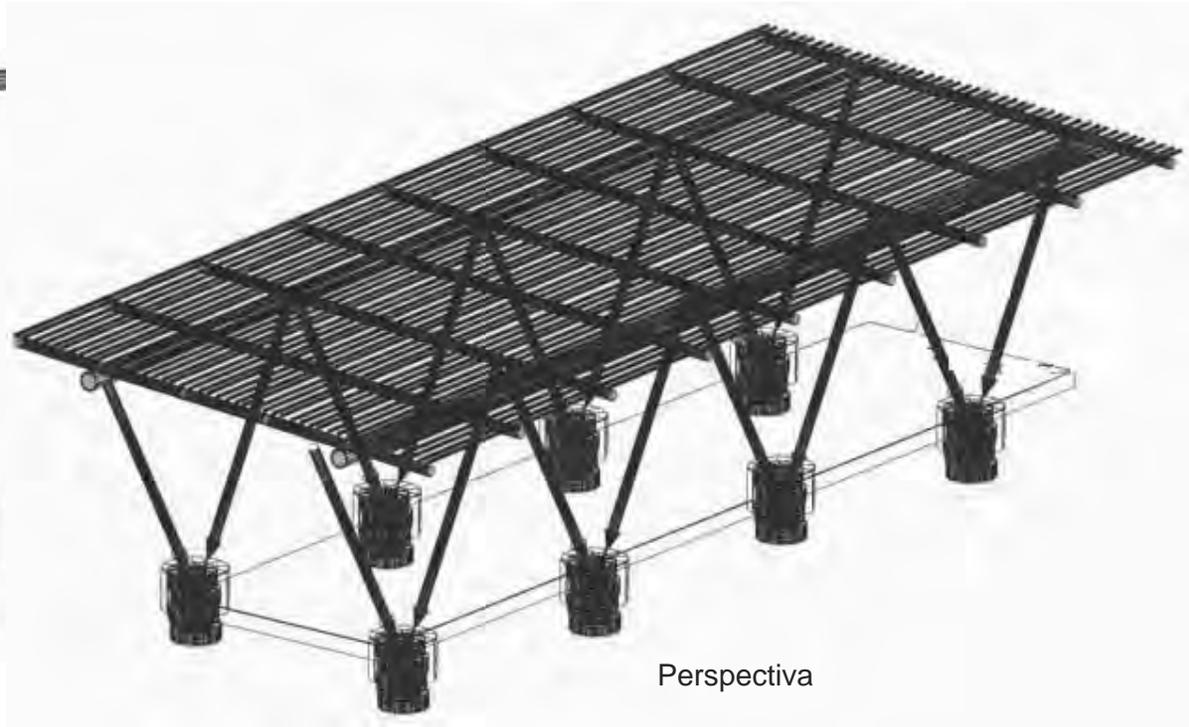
, vistas renderizadas de la estructura para la Cubierta de Andadores
